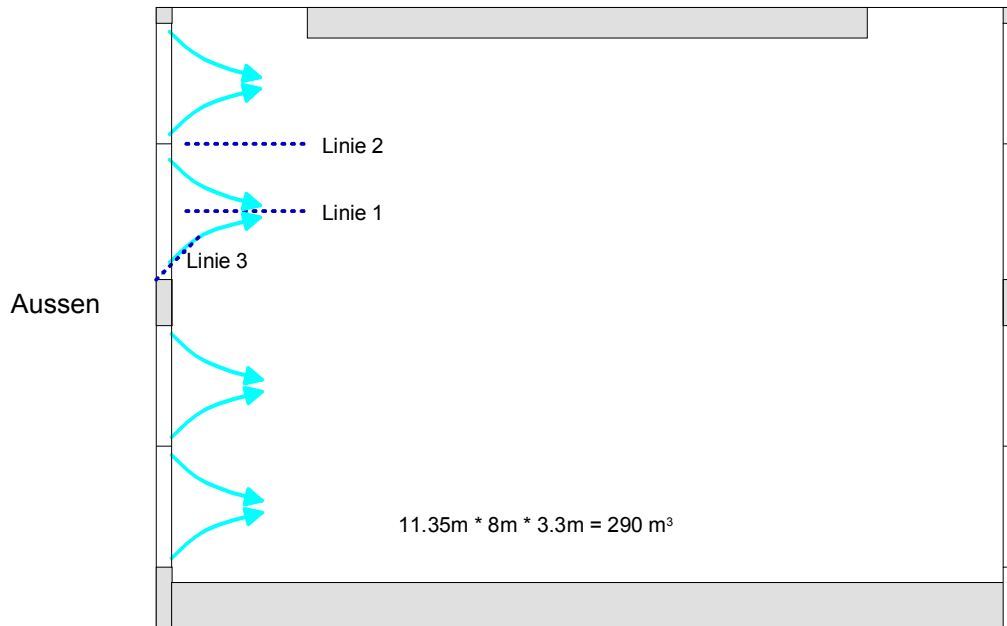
Verhältnisse Fassade in Schulhaus Chur, Grundriss.
